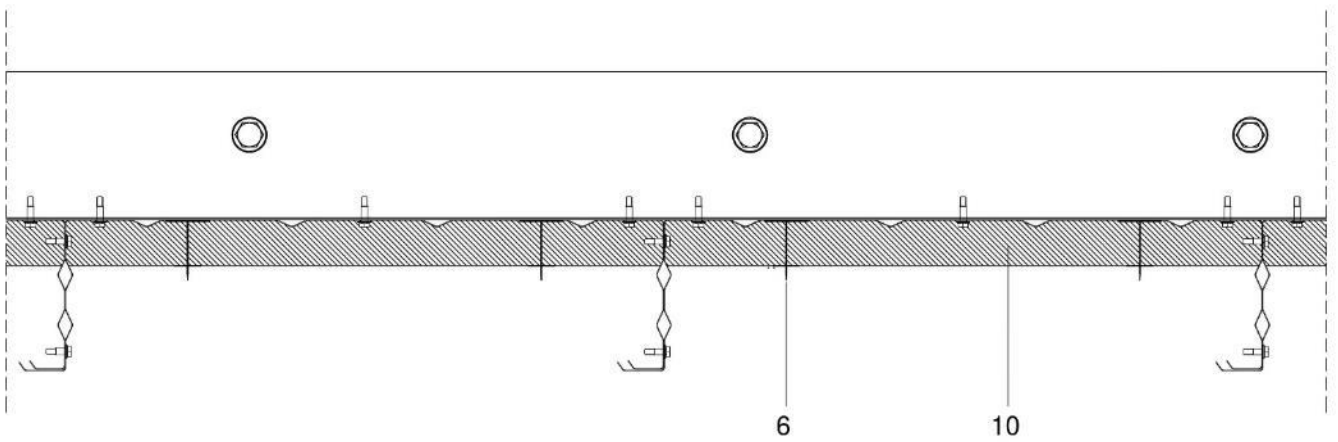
c: Sección horizontal con aislamiento térmico y fijación del aislamiento tipo 2.
